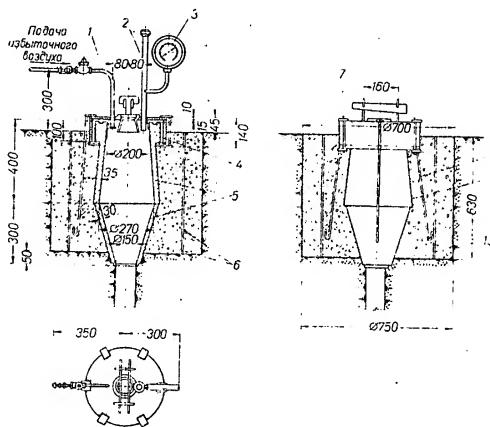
Герметический затвор з камерою сгорання для газообразного топлива:
